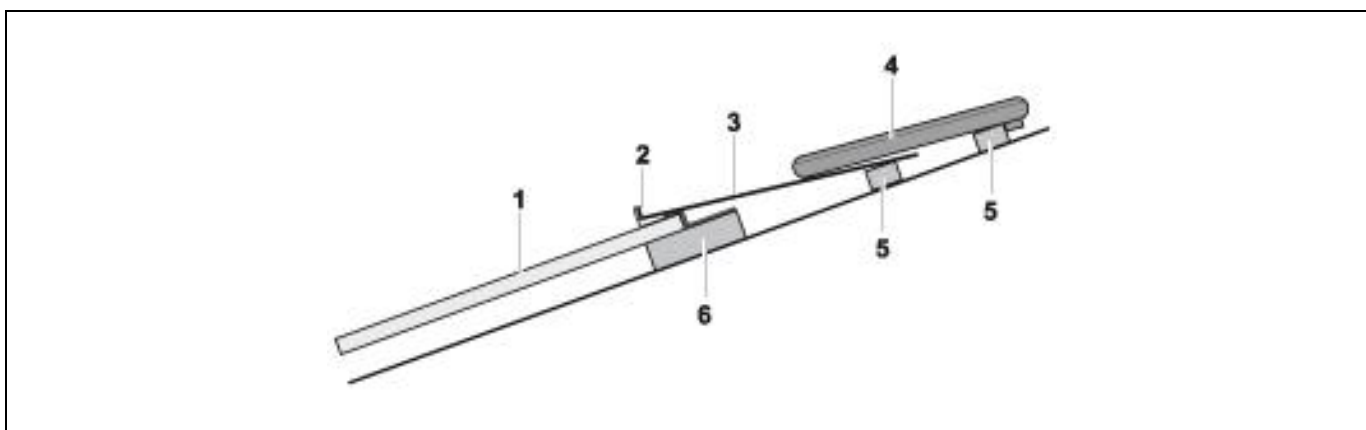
collegamento a tetto su tegola (vista da sopra)
